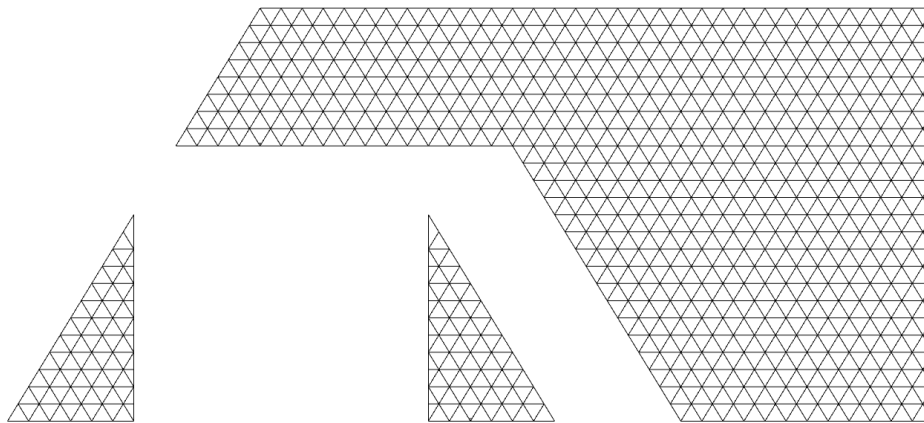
Plancha Perforada, Malla 1, Muro Acristalado, Fase 1
